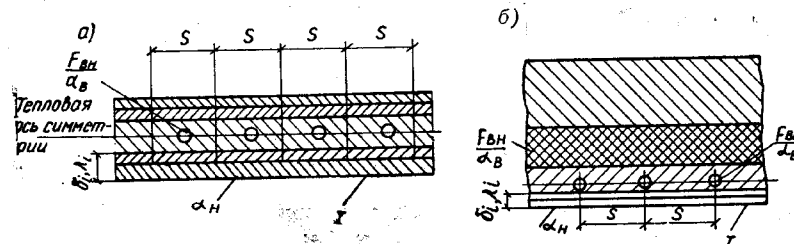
Схемы конструкций ограждений с бетонными панелями
